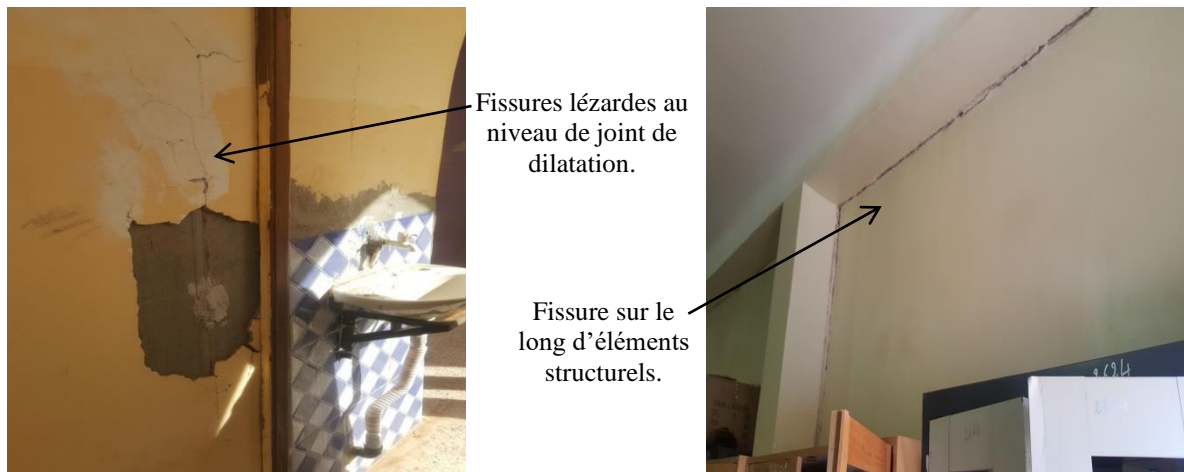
Fissuration autour du joint. Photo 2.62. Fissuration autour des éléments structurels
